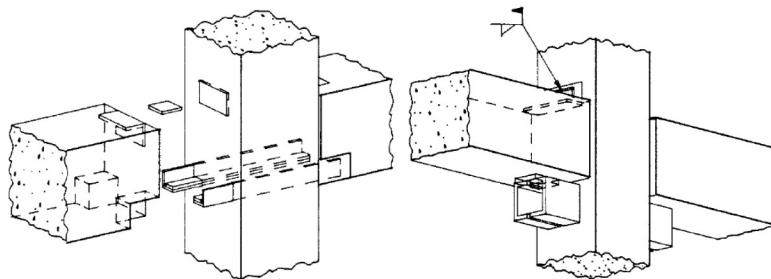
Ligação por consolo metálico (Levy, 2000)
